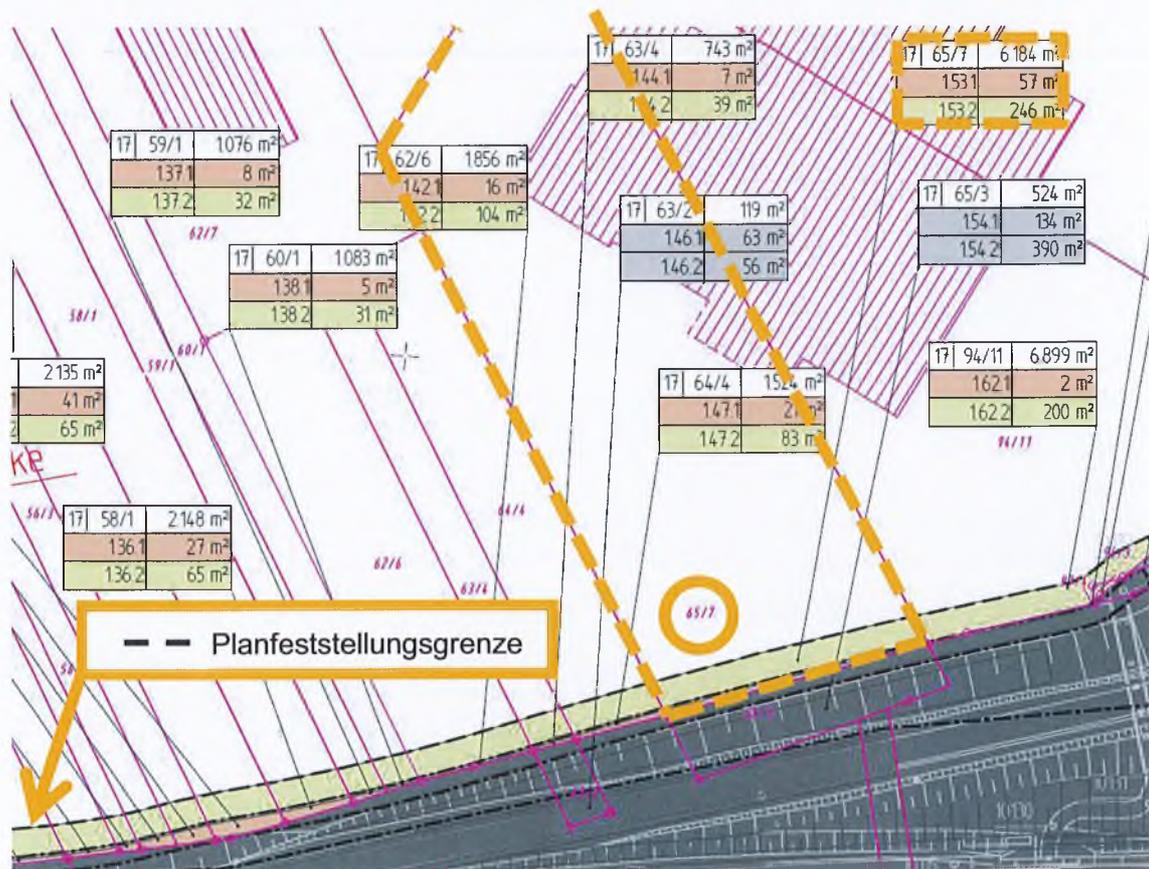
Auszug aus einem Grunderwerbsplan – Beispiel: Flurstück 65/7 (Unterlage 10.1)
